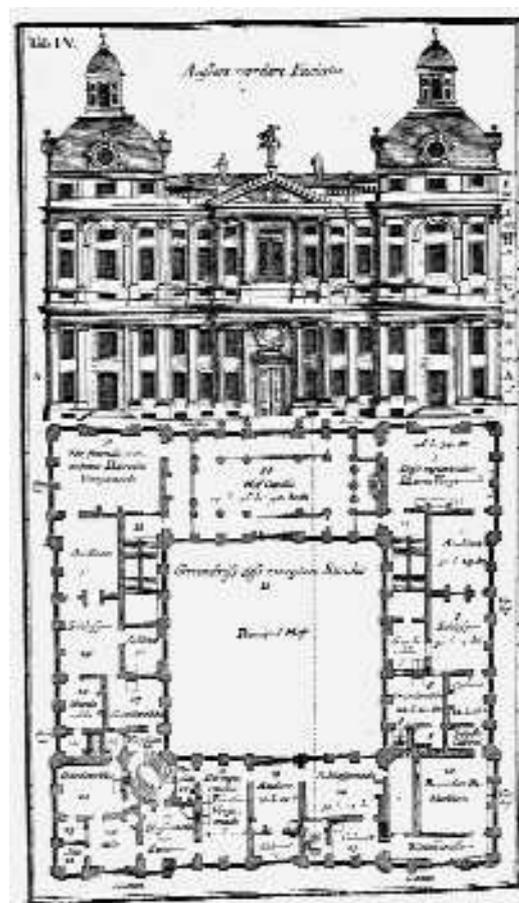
Sturm, 'Kleiner Hof', Auf- und Grundriß, 1718
